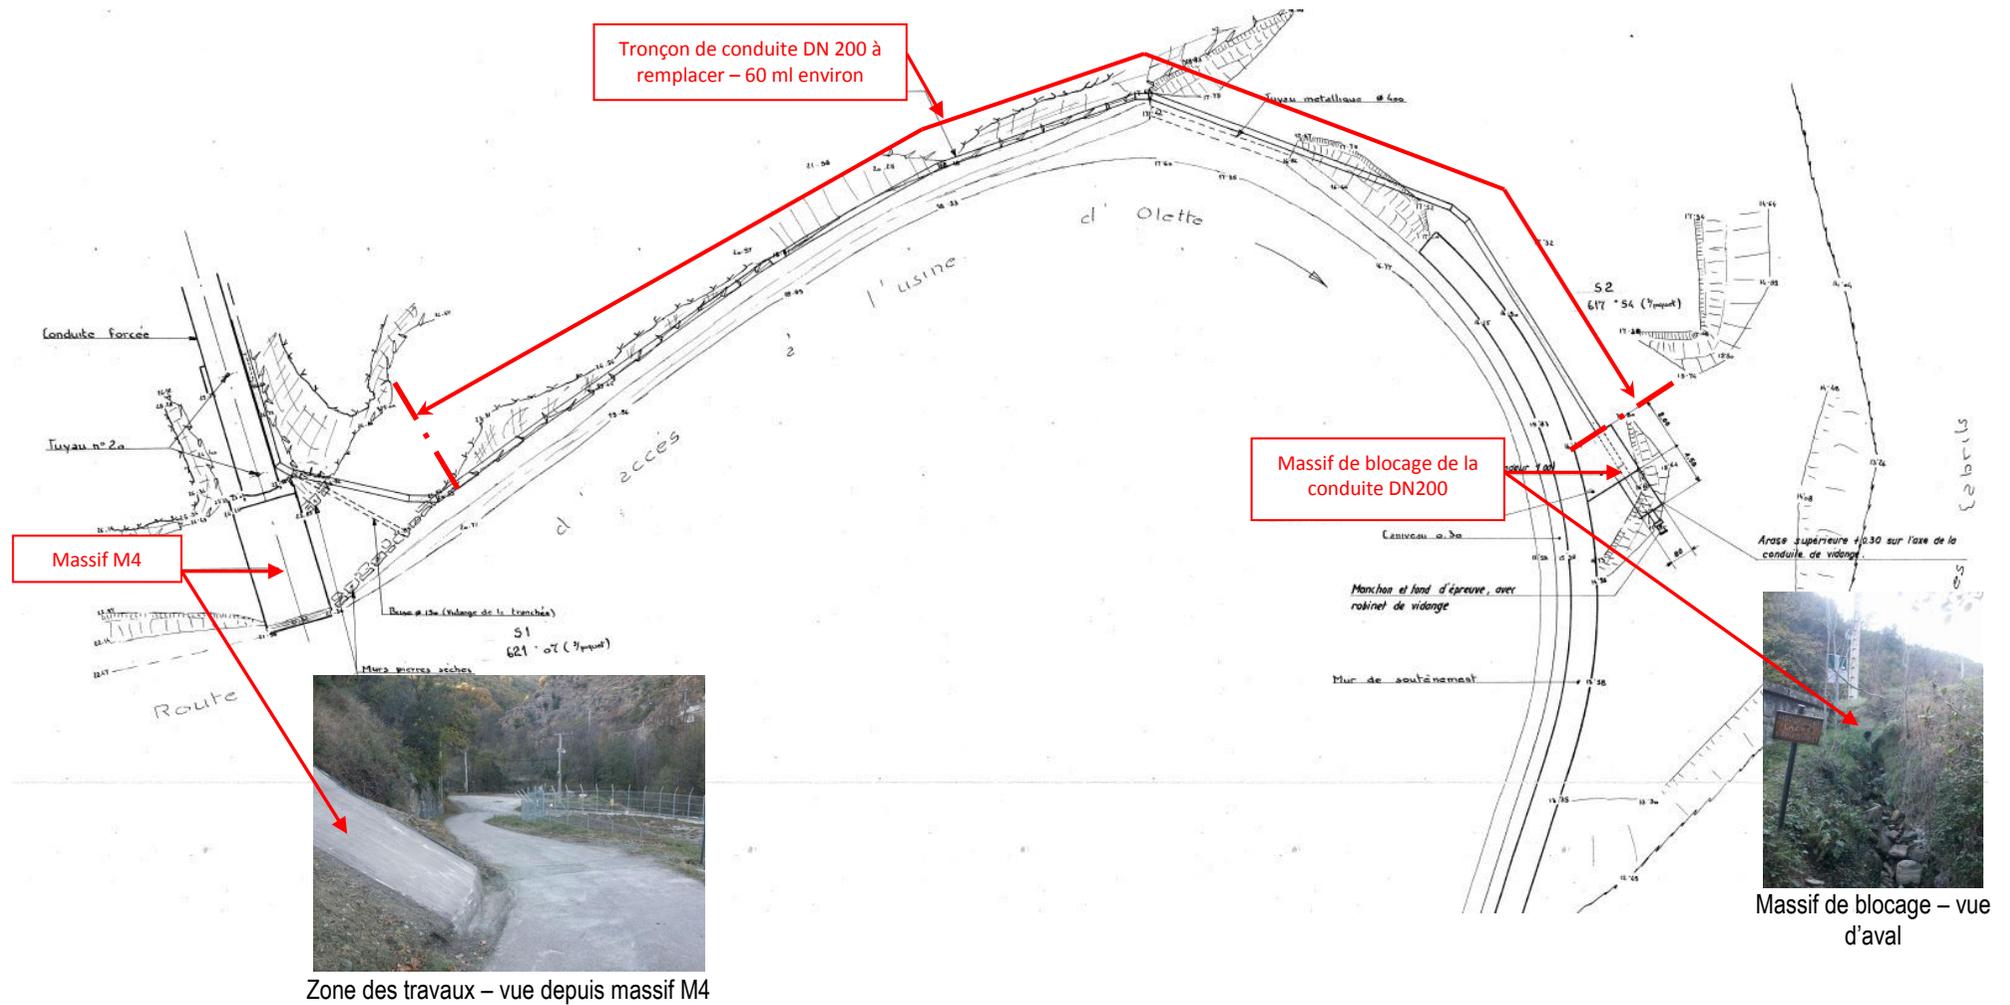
Vue en plan de la conduite DN200 enterrée – Localisation de la zone des travaux
